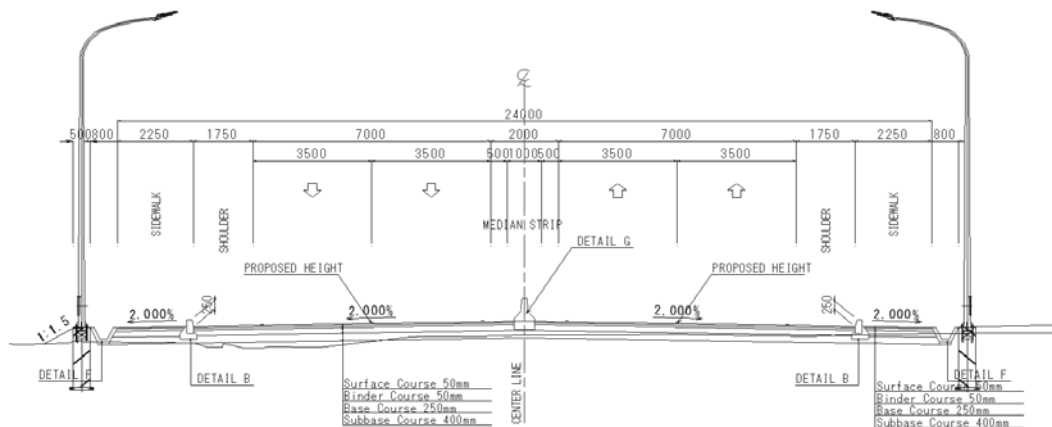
標準横断面図 (ボフタル区間 : STA.807+20 から終点まで)
